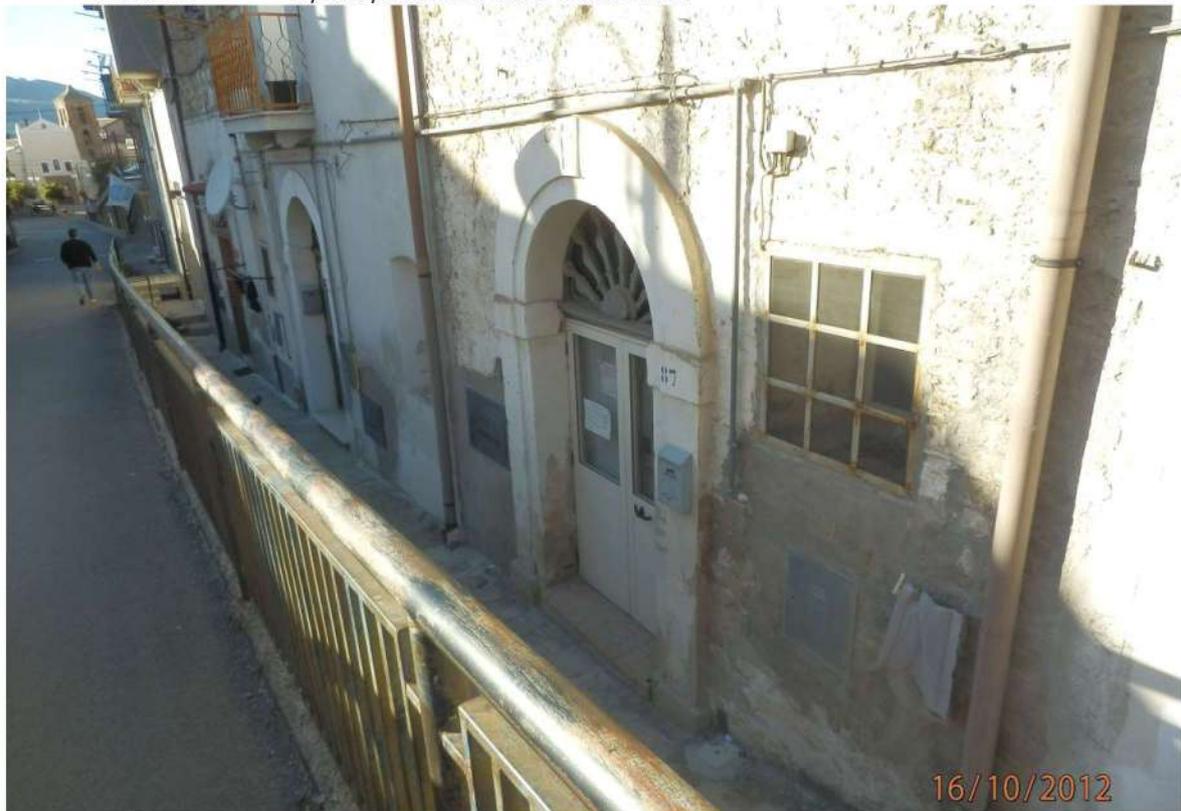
ingresso al piano terra di c.so Umberto I n. 87
